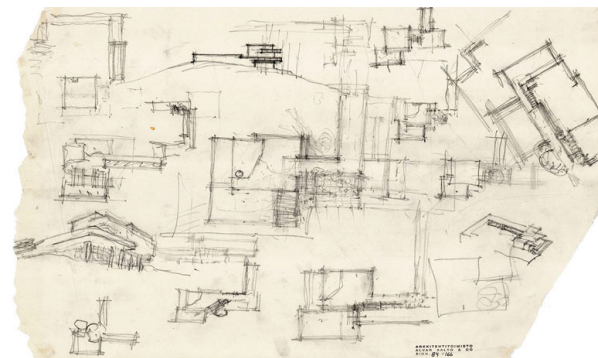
Aalto, A. (1938). Bocetos en planta, elevación y perspectiva de detalles de la vivienda. Se definen en perspectiva detalles como las columnas exteriores de la fachada. Recuperado de http://www.alvaraalto.fi/net/villa_mairea/en/22.htm
